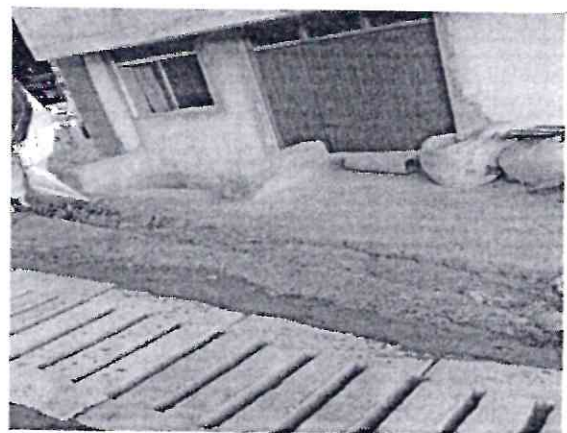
Se aprecia la construcción del canal del drenaje con tapas y rejillas de concreto en la Av. Mariano Necochea; el cual fue realizado para el drenaje de las lluvias.
